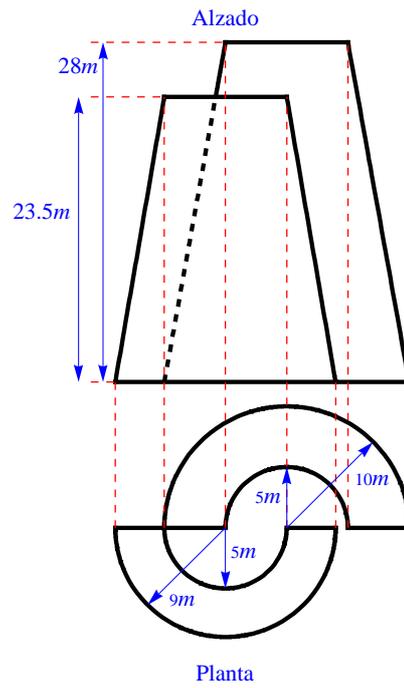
Alzado y planta de las superficies cónicas (imagen propia)
